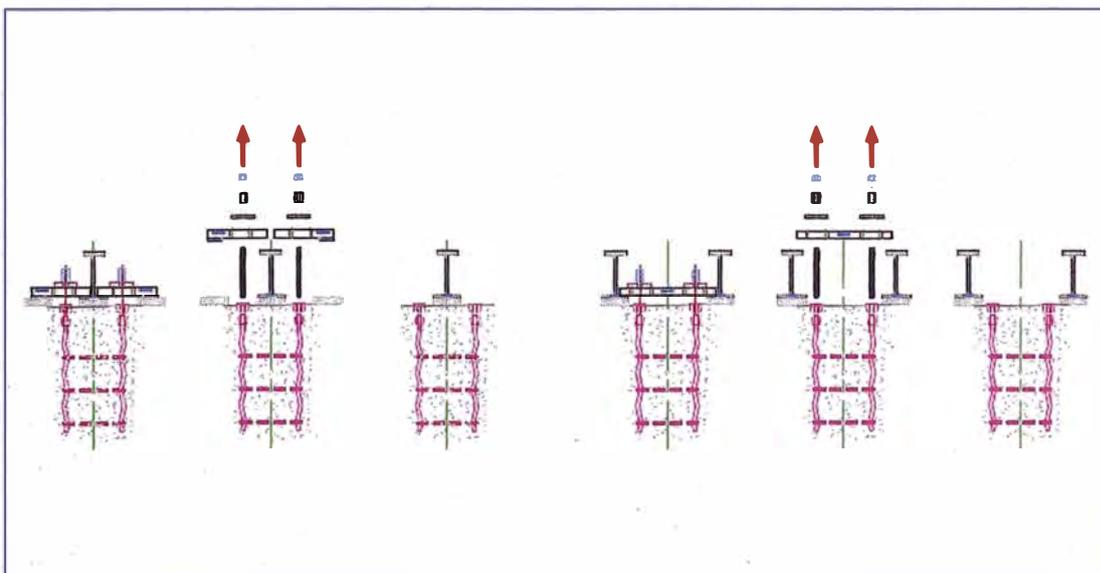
Vista sección de retiro de anclajes de los carriles - Fuente: Elaboración Propia
